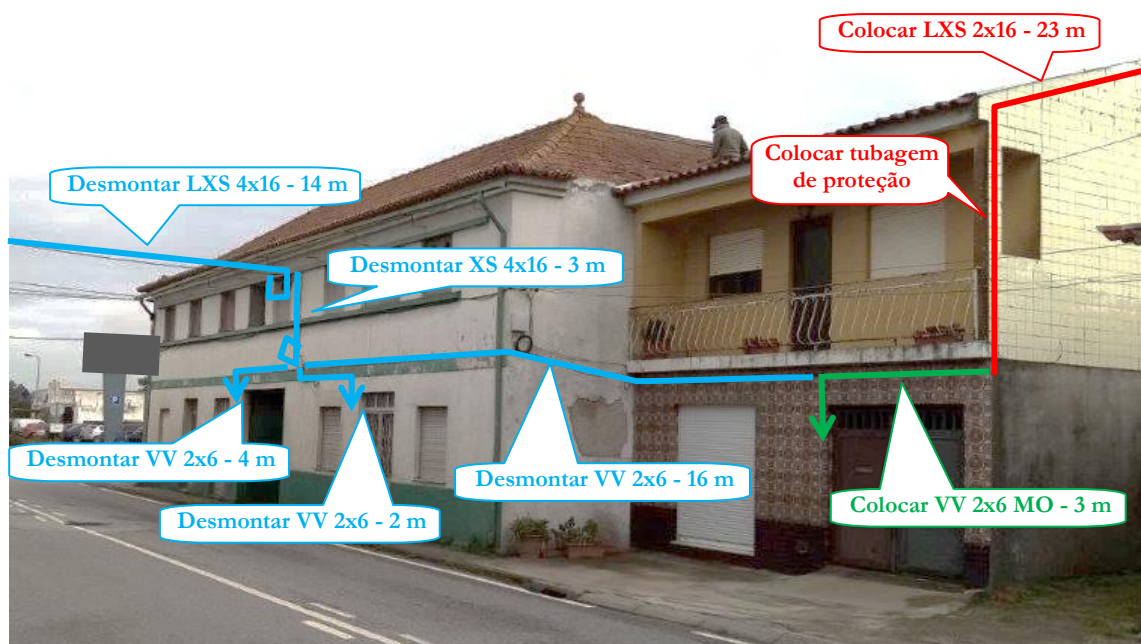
Exemplo de uma modificação de rede em fachada.
